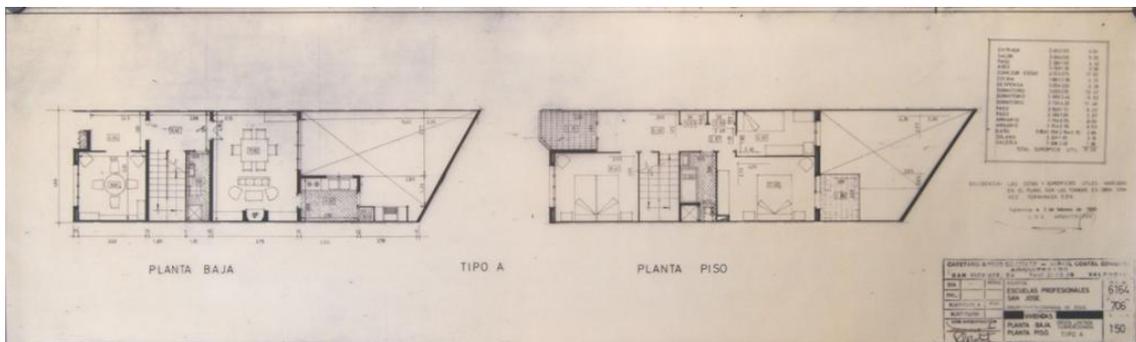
Plano vivienda tipo. Archivo Escuelas San José.
